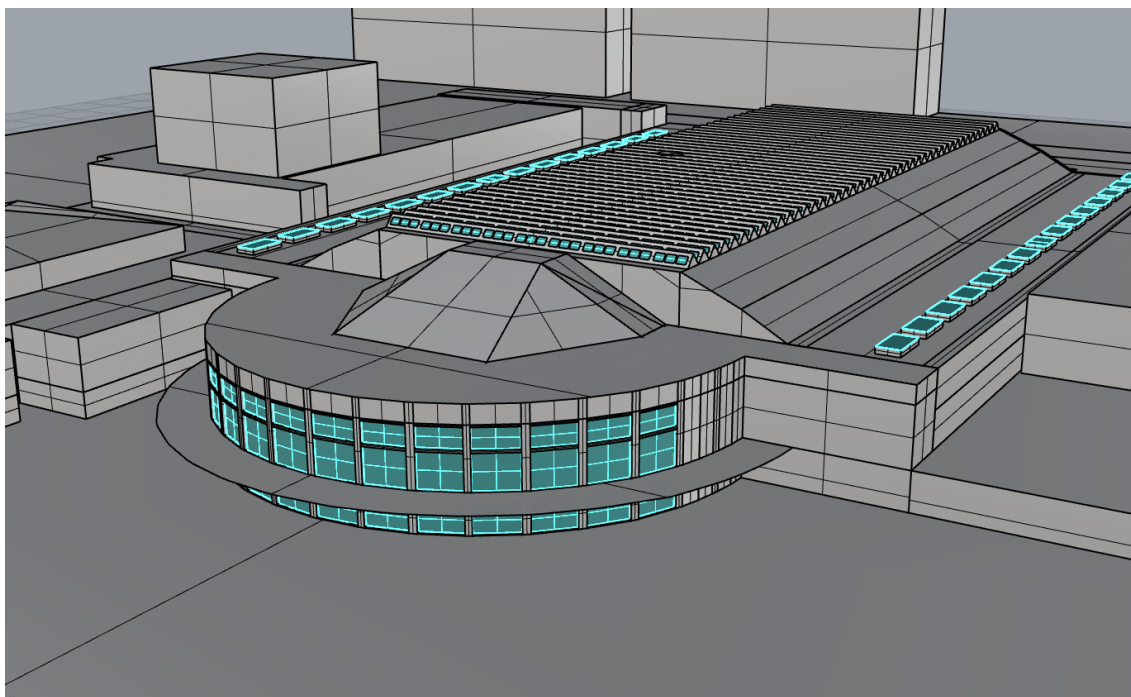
Modello 3D: vista del prospetto Sud/Sud-Est
